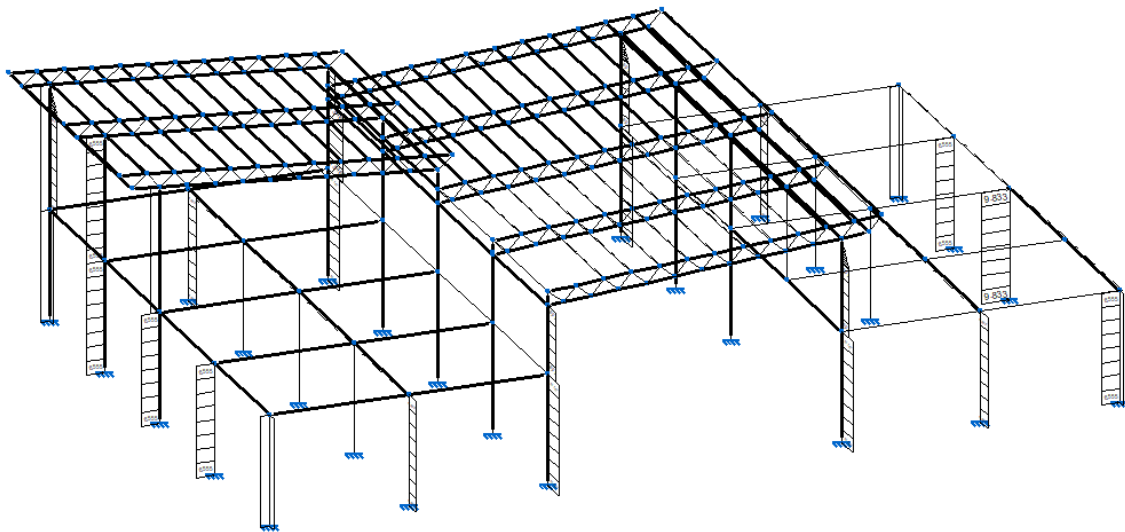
Sobrecargas de viento en estructura metálica. Fuente: Elaboración propia
